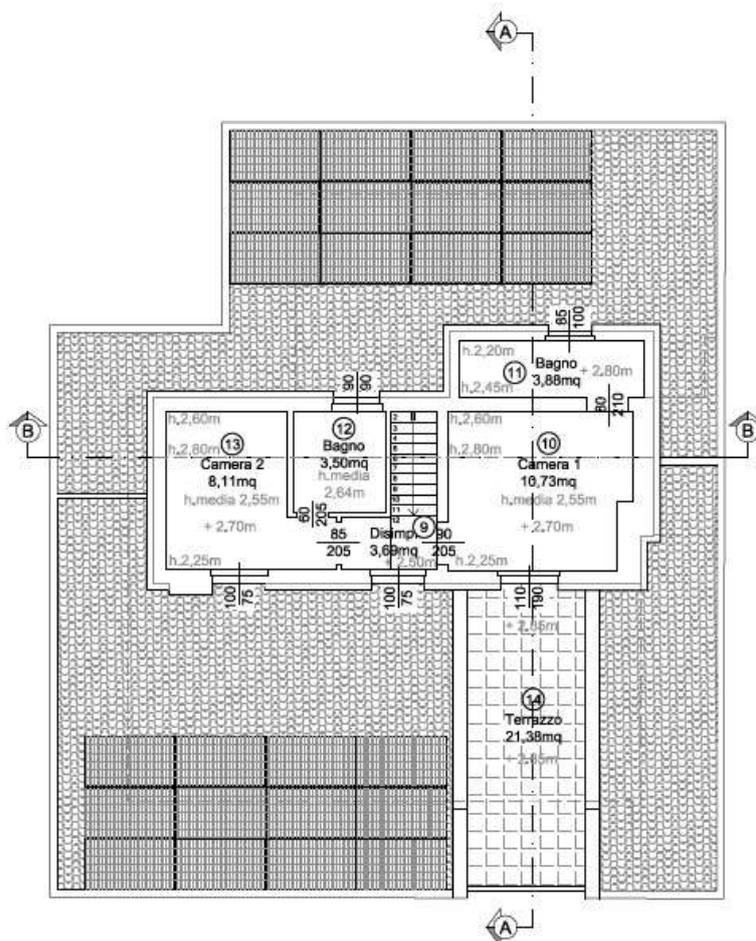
VARIANTE ALLA SCIA n°14755 del 13/12/2022 stralcio tavola di progetto in variante del piano primo
